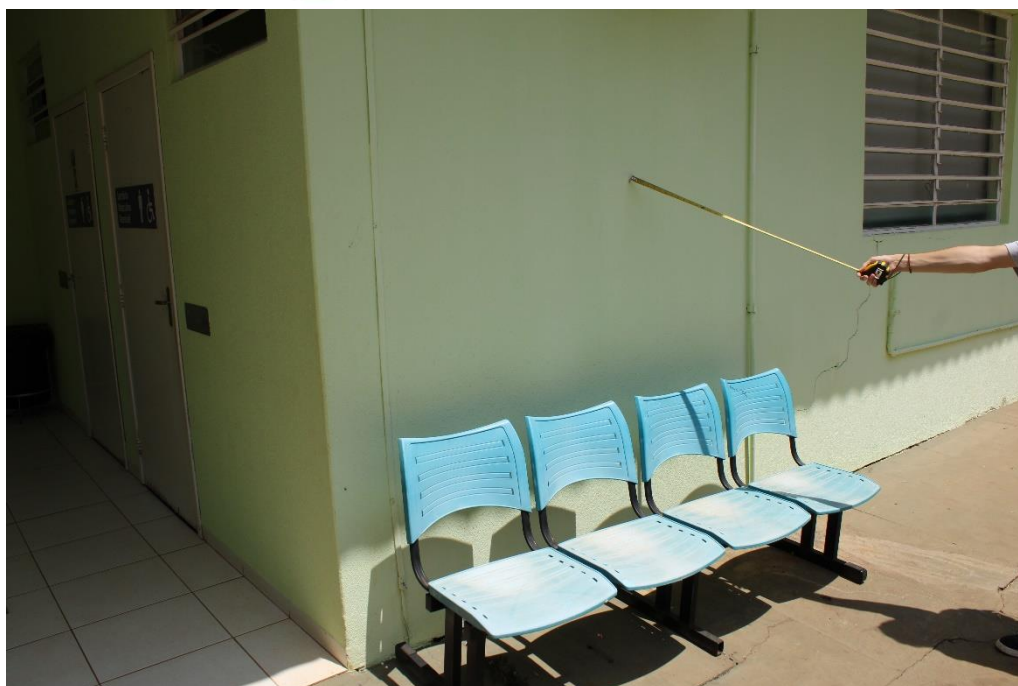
Vista parcial da Fachada Lateral Esquerda (região do bwc masculino), destacando fissura de conformação horizontal.
